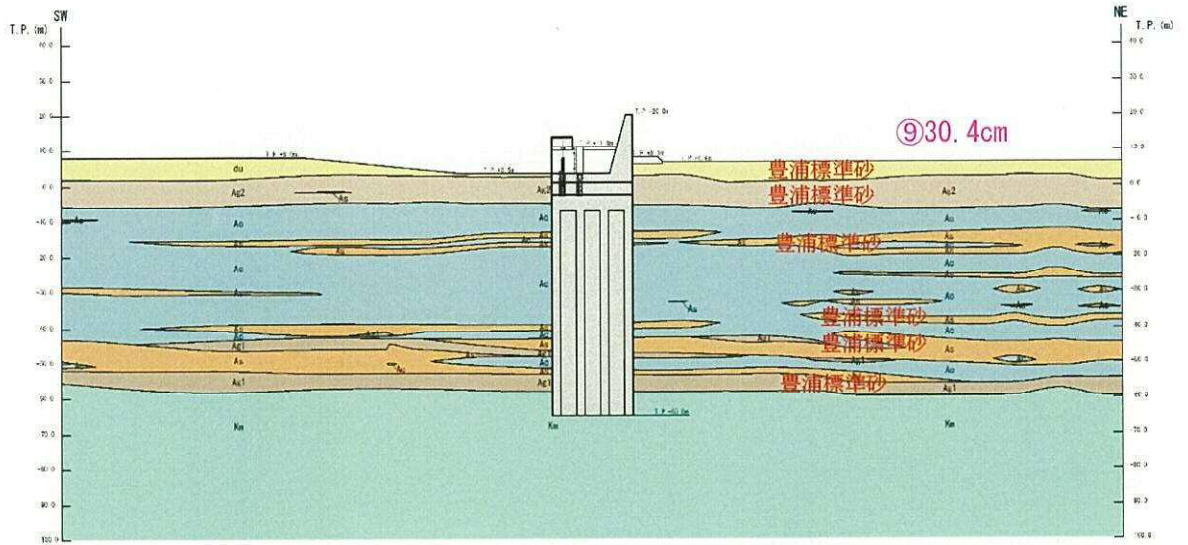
(7/10) 鉄筋コンクリート防潮壁 (放水路横断面) 断面図 (2次元有効応力解析)
